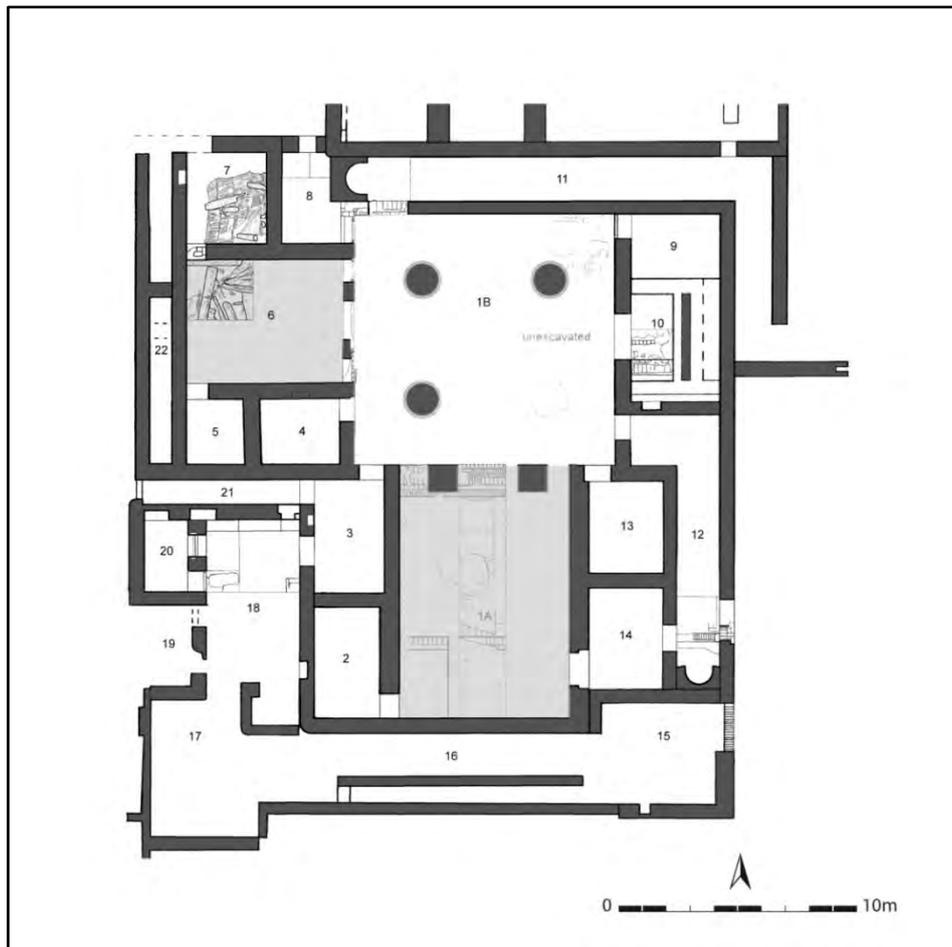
Kellis: planimetria dell'edificio B/3/1. Rielaborazione da HOPE 2015, p. 207, Fig. 5.
